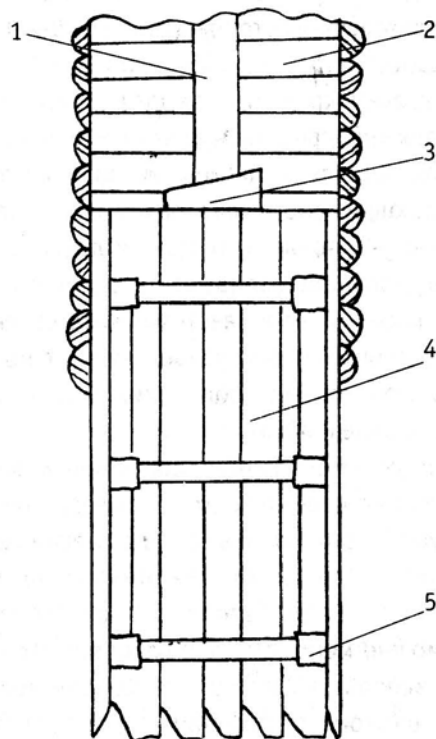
Прохождение пльвуна шпунтовым ящиком:
